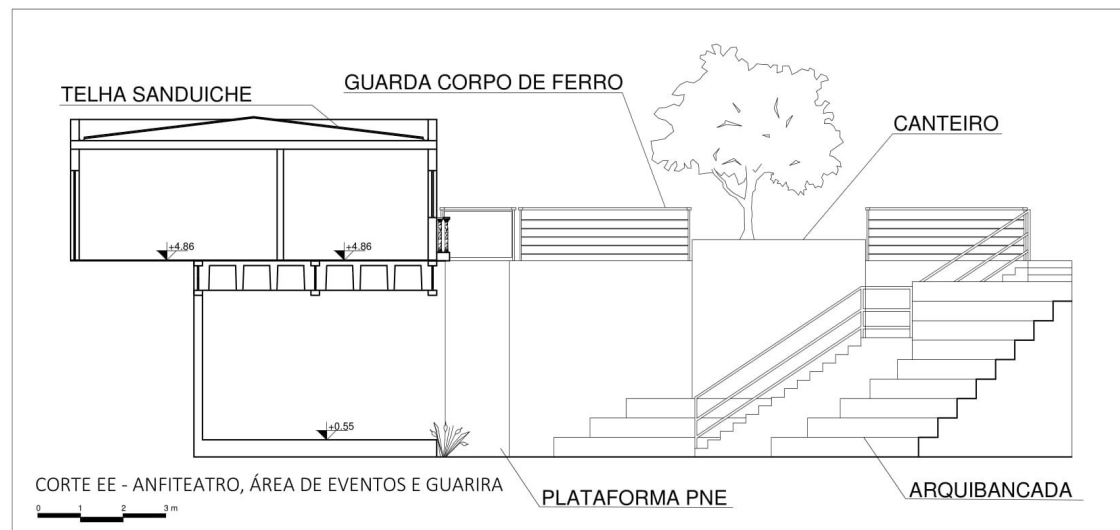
Cortes esquemáticos da proposta, pág. 102
